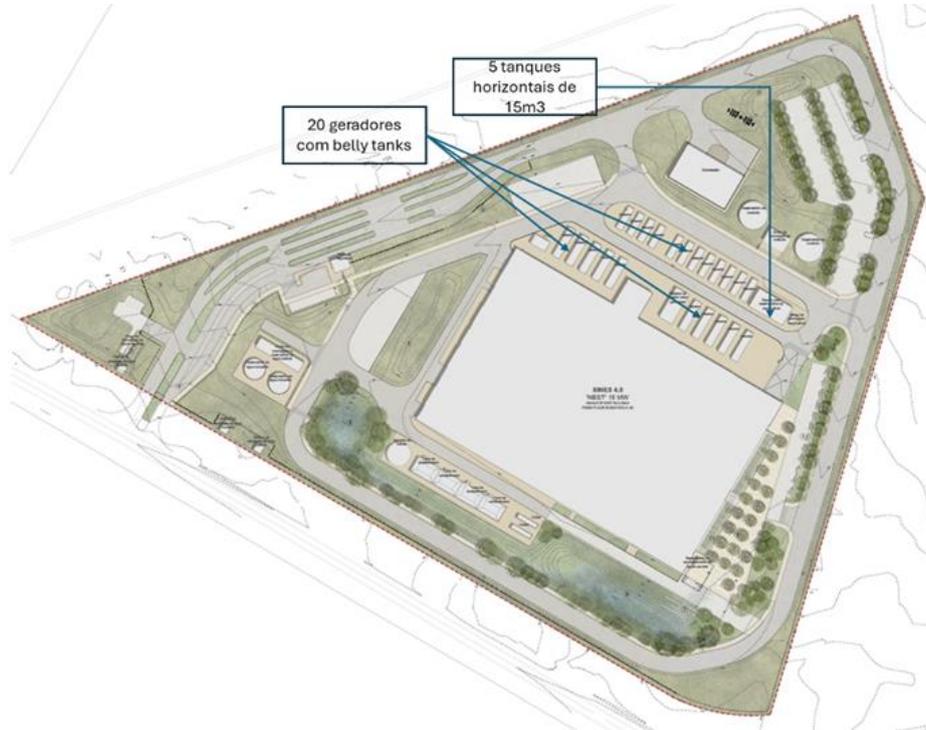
Planta Geral do Estabelecimento NEST ou Sin01 e localização dos tanques.
